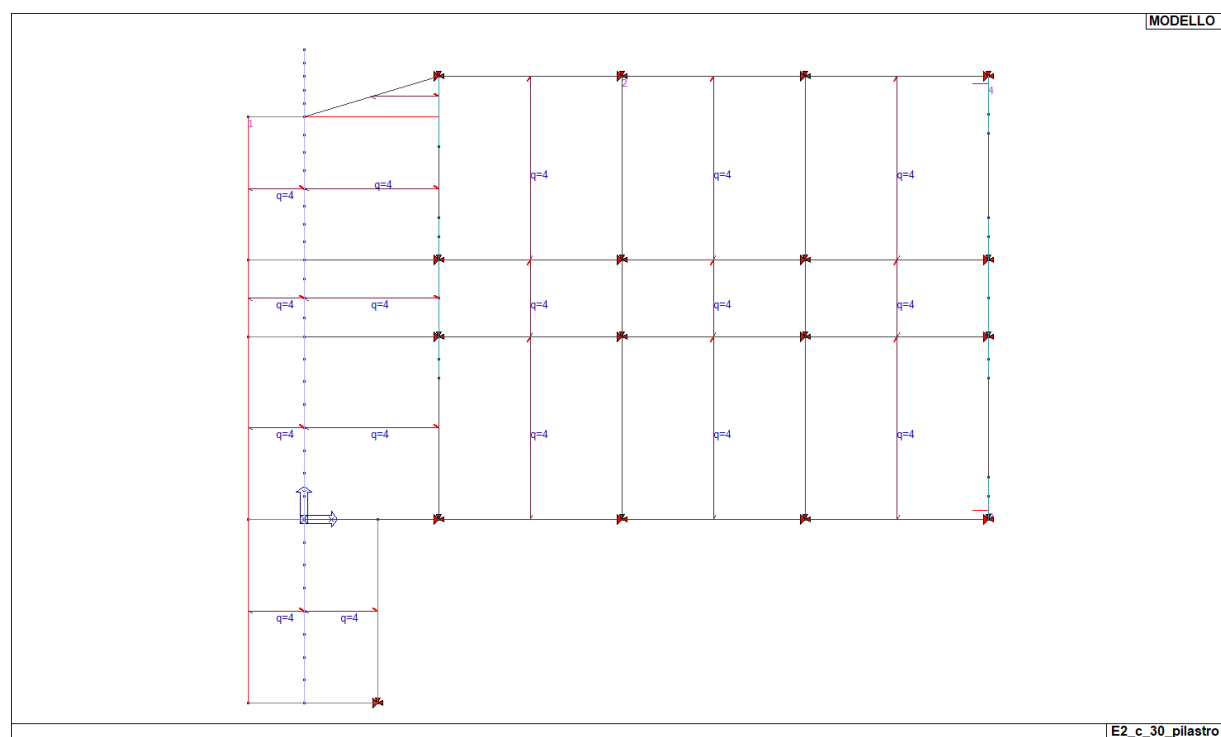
pianta solaio con indicazione tipologia solaio – pianta piano terra
